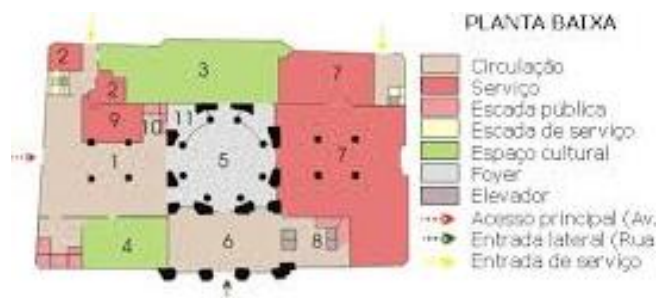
Planta Baixa Térreo - Centro Cultural Banco do Brasil (1989), Arq. Luiz Telles.
